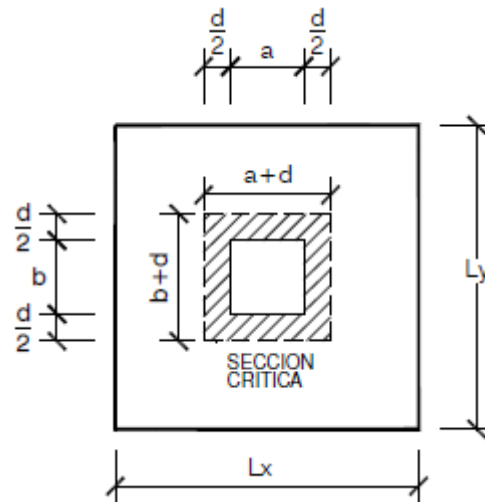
Dimensiones de la sección crítica en la zapata.
